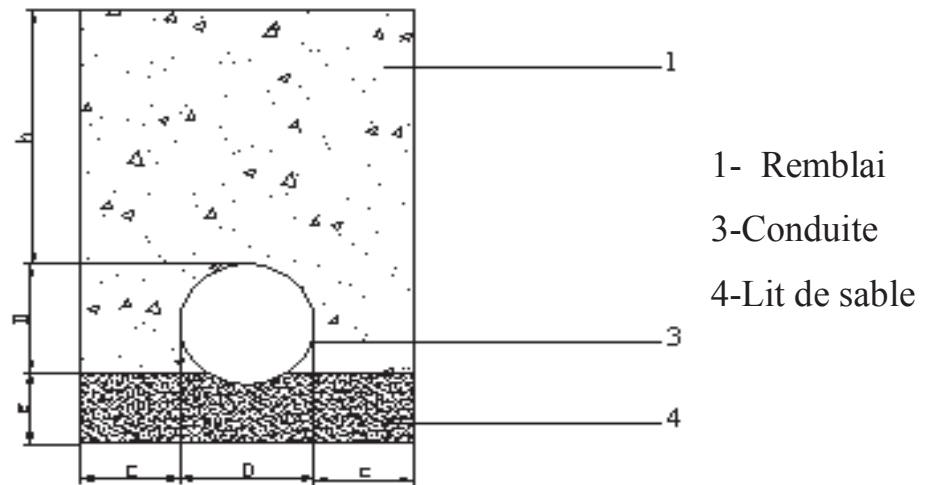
Coupe transversale d'une tranchée avec la mise en place de la conduite
